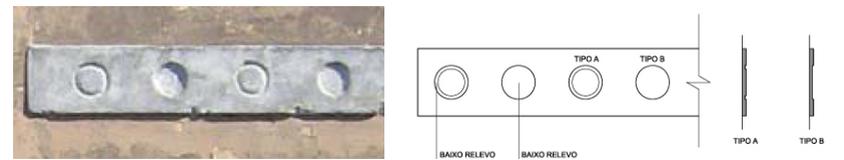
, 29 e 30 À esquerda, foto e desenho de um exemplo de situação de porta de entrada em 2009 e, à direita, proposta de restauração.
